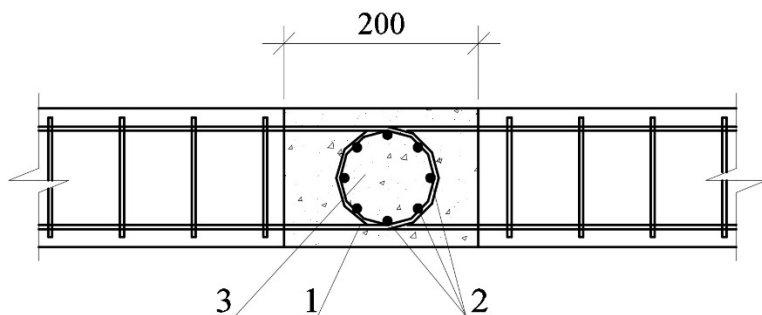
Стык Г.И. Передерия при соединении сборных элементов антисейсмических поясов: 1 – петлевые выпуски; 2 – фиксирующие арматурные стержни; 3 – монолитный бетон
